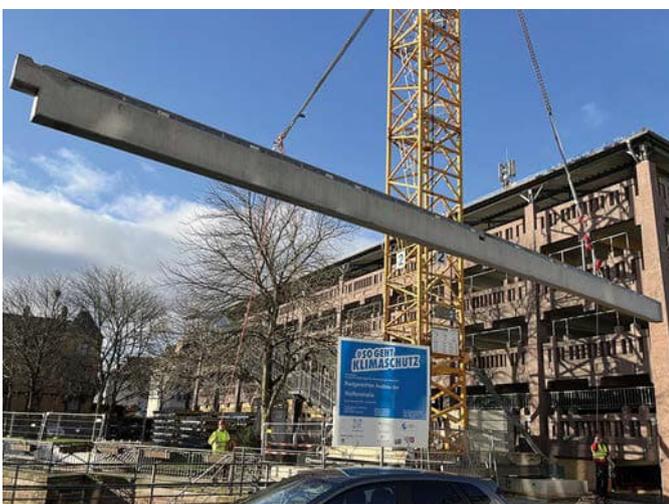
Einfädeln eines Spannbetonsträgers durch die Fassadenelemente des Parkhauses
